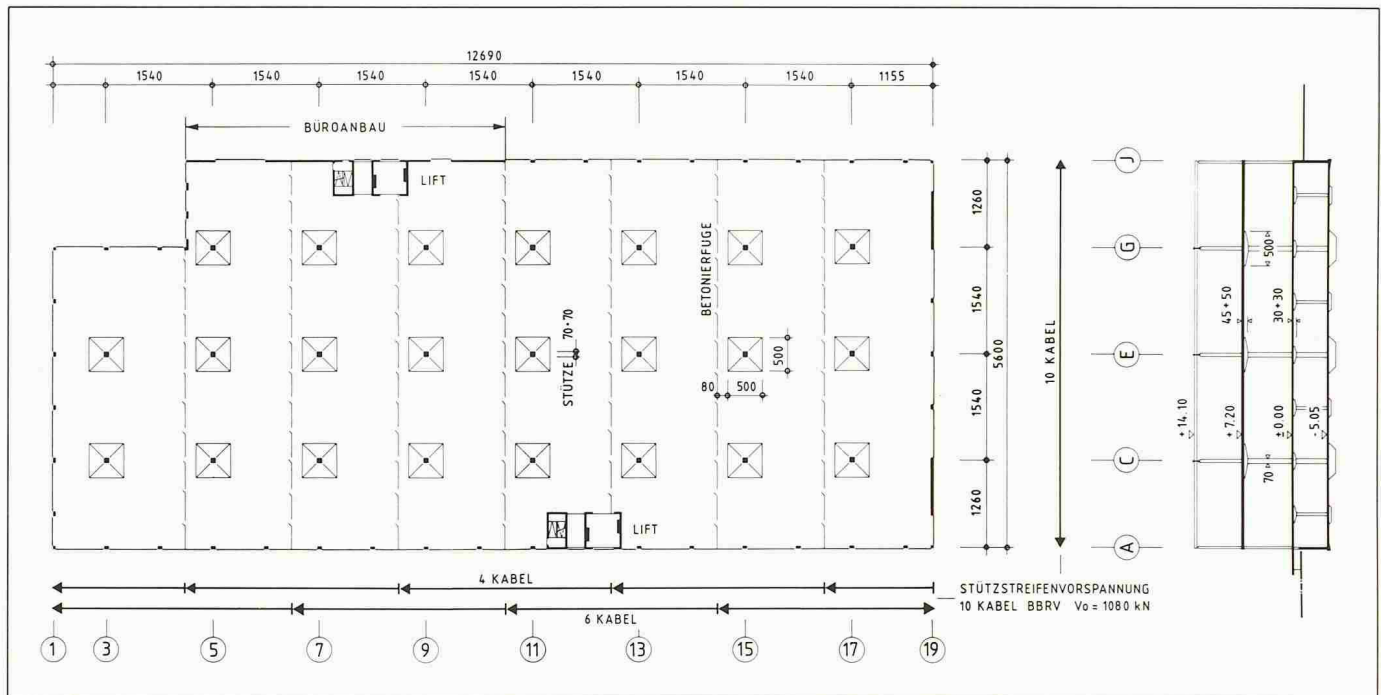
Grundriss der Decke über Erdgeschoss mit Kabelanordnung und Betonieretappen. Querschnitt des Gebäudes
